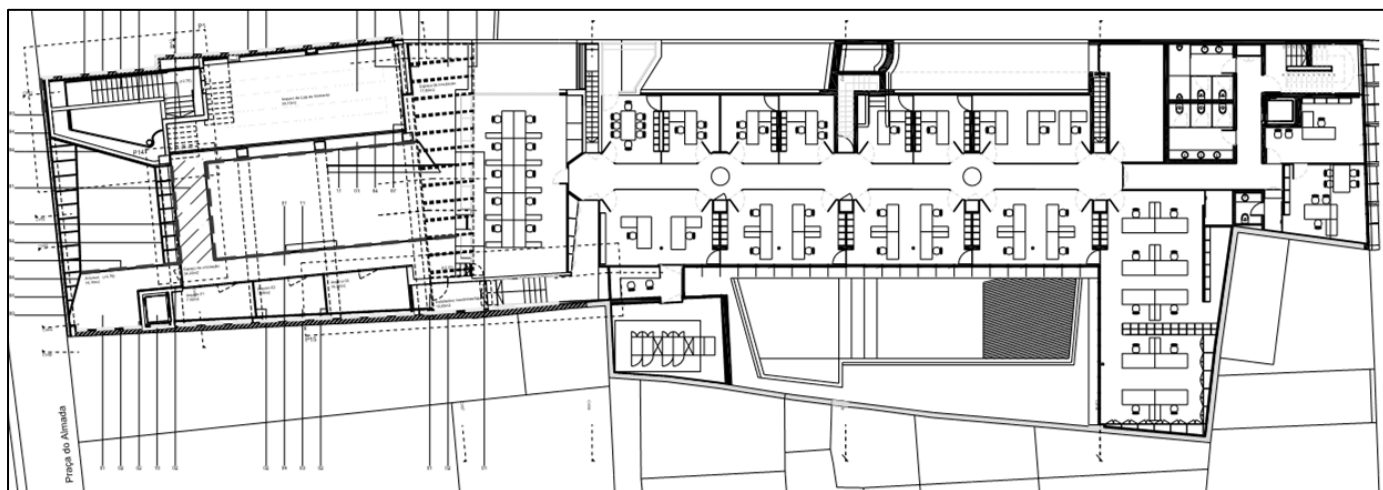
Planta do Caso de Estudo 2 – Edifício de Serviços/Comércio
